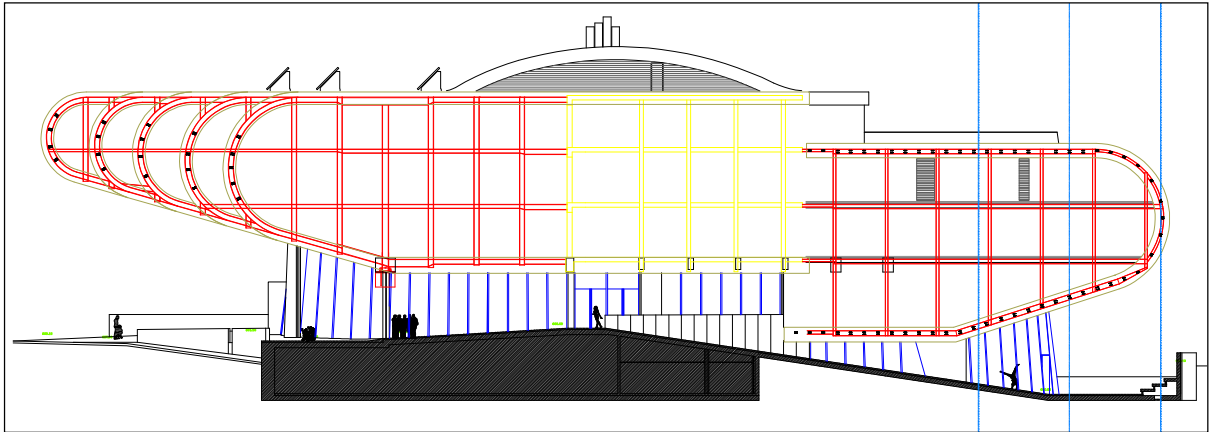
Desenho de alçado sudeste da estrutura metálica e de betão da obra.
